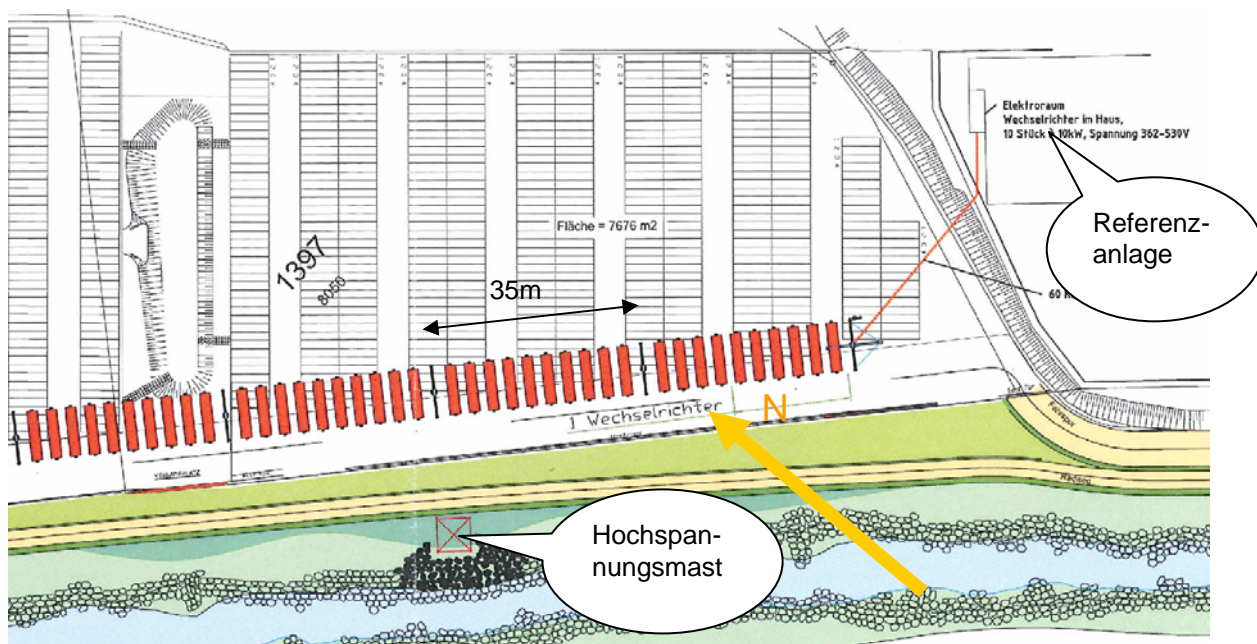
Konzept der beiden PV Systeme, Messobjekt: zweiachsige Solar Wings Nachführung und das Referenzsystem: baugleiche Module mit 30° Neigung exakt nach Süd orientiert auf dem Betriebsgebäudes im oberen rechten Bildbereich. (Zeichnung, Pamag Engineering, Flums, Nr. 091240) Sechs Modulträger werden mit einem 10kW Wechselrichter zusammengefasst. Der Nordpfeil zeigt die Abweichung mit 45° aus der Südrichtung der Tragseile.
